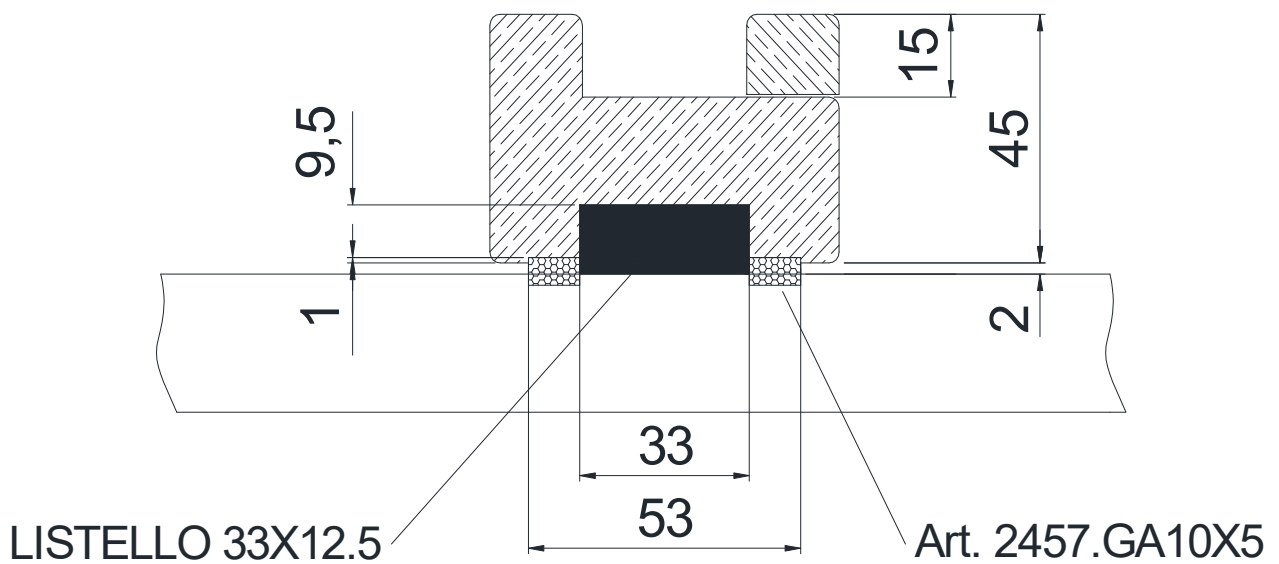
Coupe et emplacement du travers bas du vantail primaire et secondaire de la maquette soumise à l'essai (dimensions nominales déclarées, exprimées en mm)
